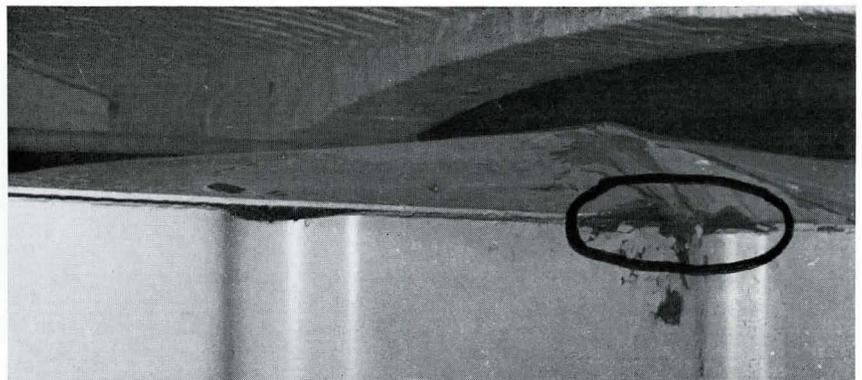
Riß der Tankdecke im südöstlichen Tankdeckenbereich. Gesamte Tankdecke aufgewölbt.
